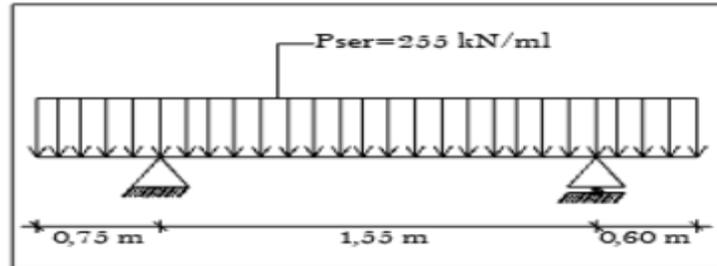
Schéma statique de la poutre raidisseuse (45x65)
